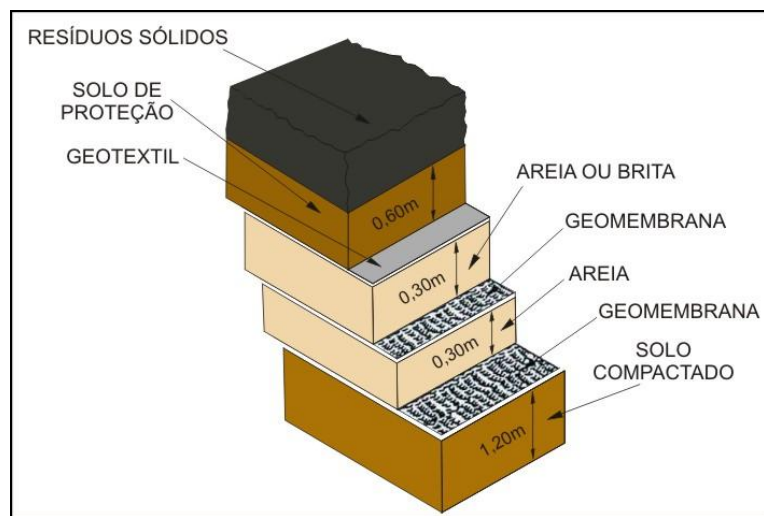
Esquema da Impermeabilização Inferior das Bacias Industriais
